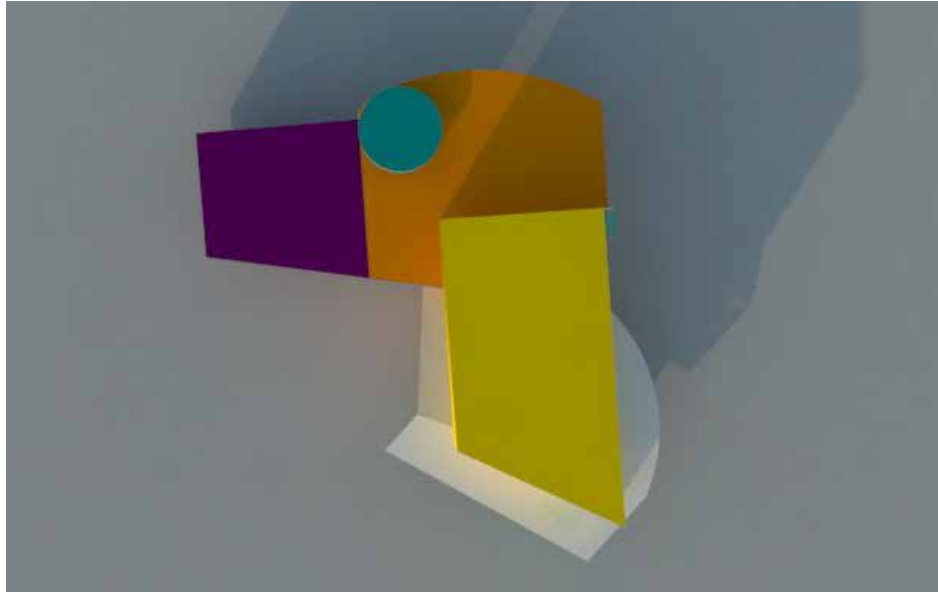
Planta Techo del Volumen, *La Autora*, (2018).
